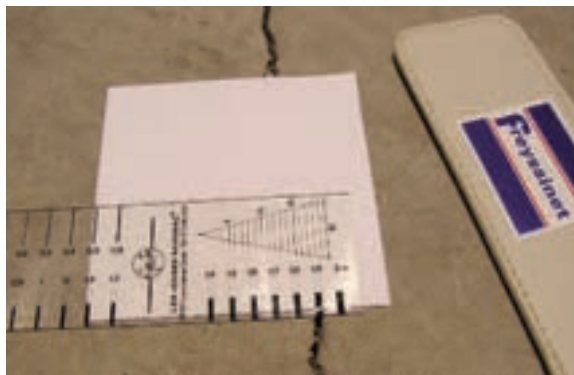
utilisation d'un fissuromètre Sagnac (crédit photo Freyssinet)
